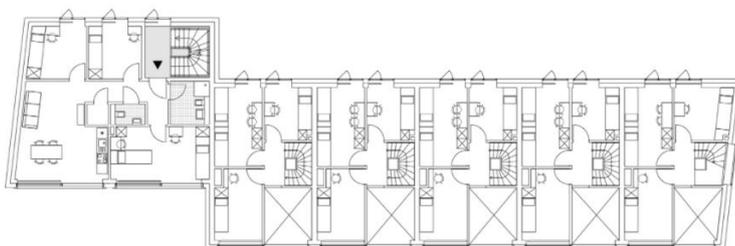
Planta do 1º piso do edifício Henry Korner Hall
